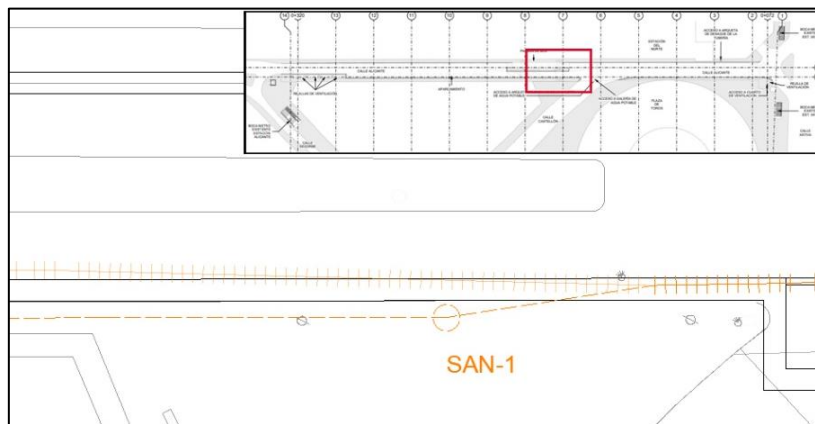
Plano de desvío SAN-SAN1-SR-SC-F3. Zona final
